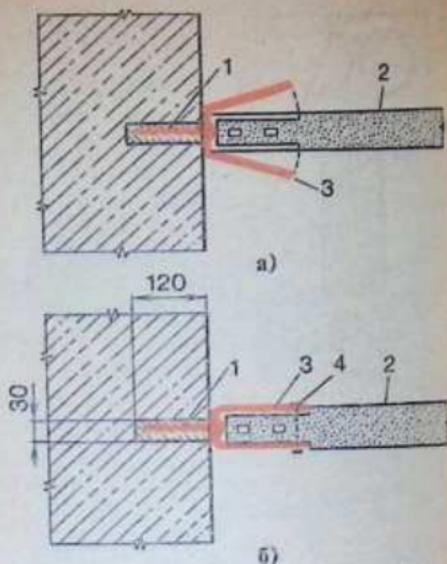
Крепление панельных перегородок к стенам вилочной скобой:
